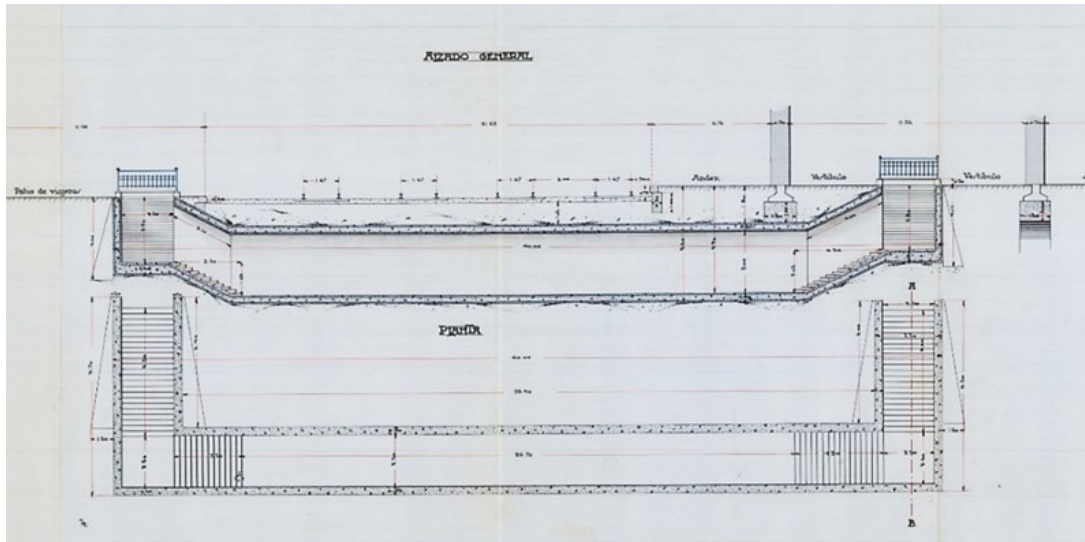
Planta y alzado del paso subterráneo de acceso al Edificio de Servicio, según proyecto de José Roselló en 1924. AGA, Caja 24/12870, Anexo XI.
